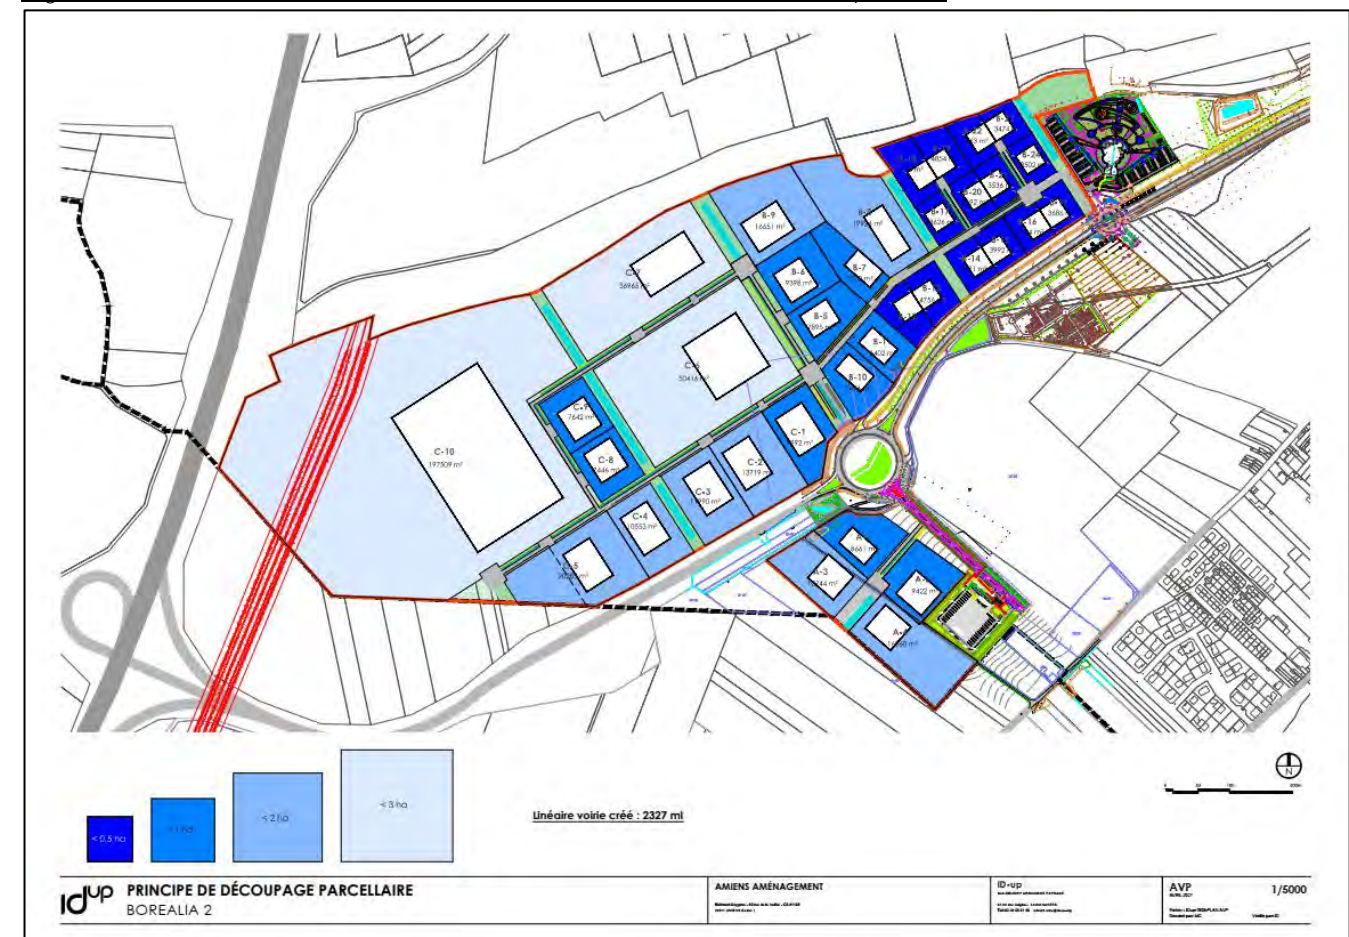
Plan de masse de la ZAC de Boréalia, secteur sur Amiens uniquement
